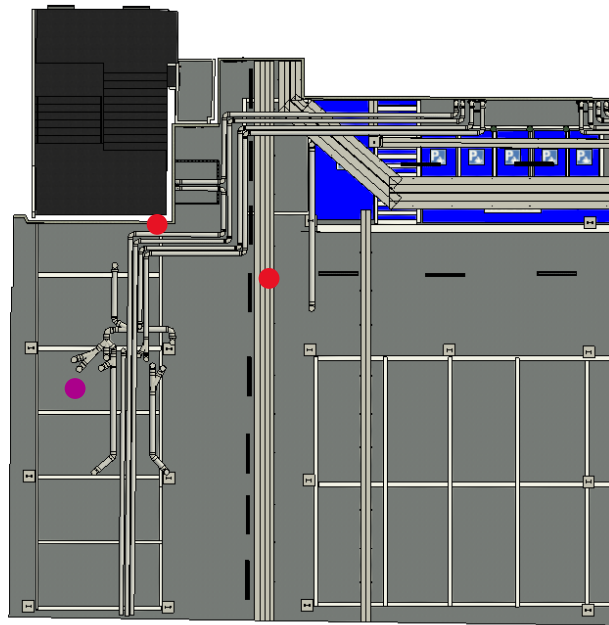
Plano Estación número 1 Fuente: Elaboración Propia
